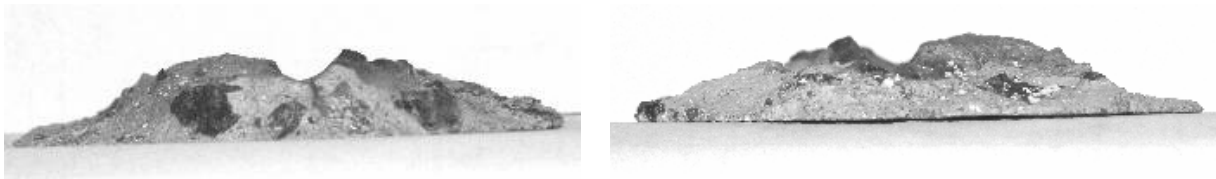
Фото зразків сколювання бетону внаслідок корозії арматури
